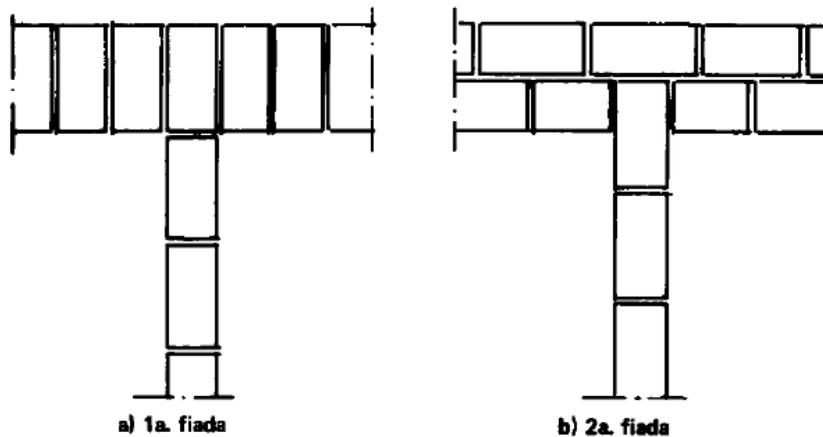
Amarração das fiadas em parede de meia vez com parede de uma vez.
